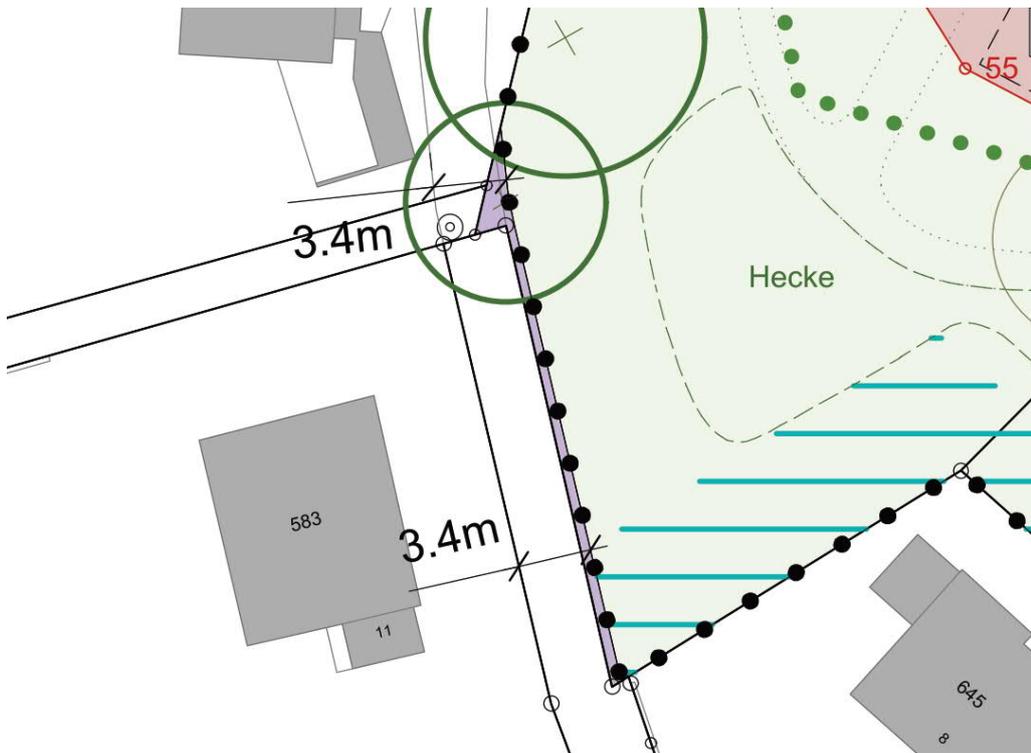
Flächenabtretung (Auszug Situationsplan)
